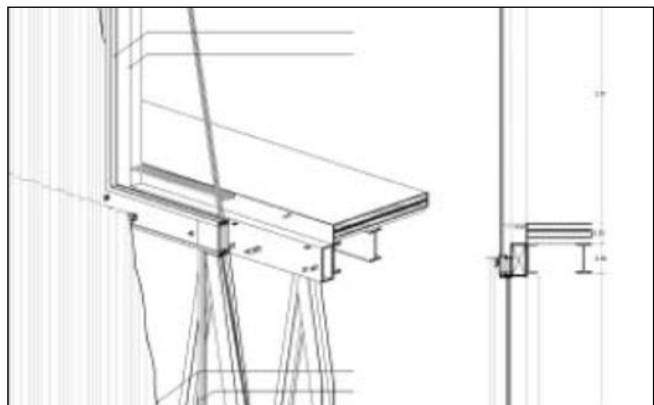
La fixation d'une mantille en tôle sur les poutres métalliques
